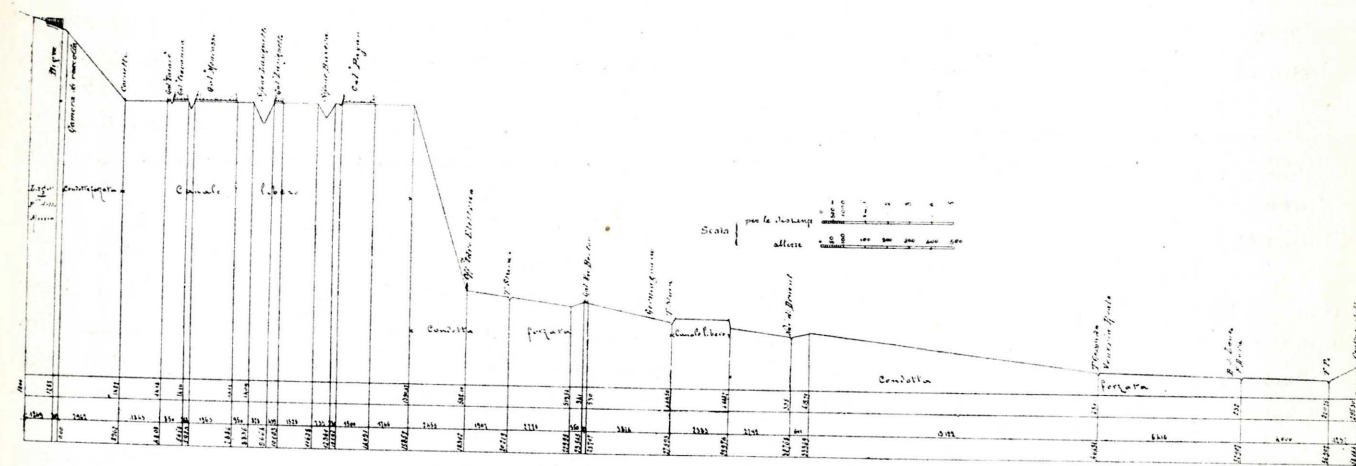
FIG. B. — ACQUEDOTTO DEL PIANO DELLA MUSSA — Profilo longitudinale.
